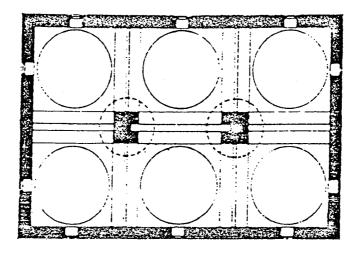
مسقط أفقى لوالده خان في استانبول (عن : جودوين) .
